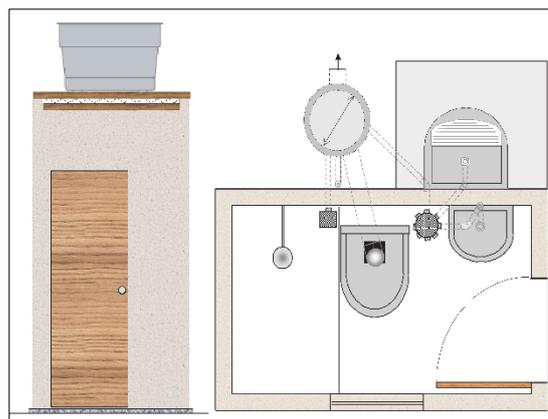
Desenho e planta baixa do modulo sanitário proposto pela Funasa.
